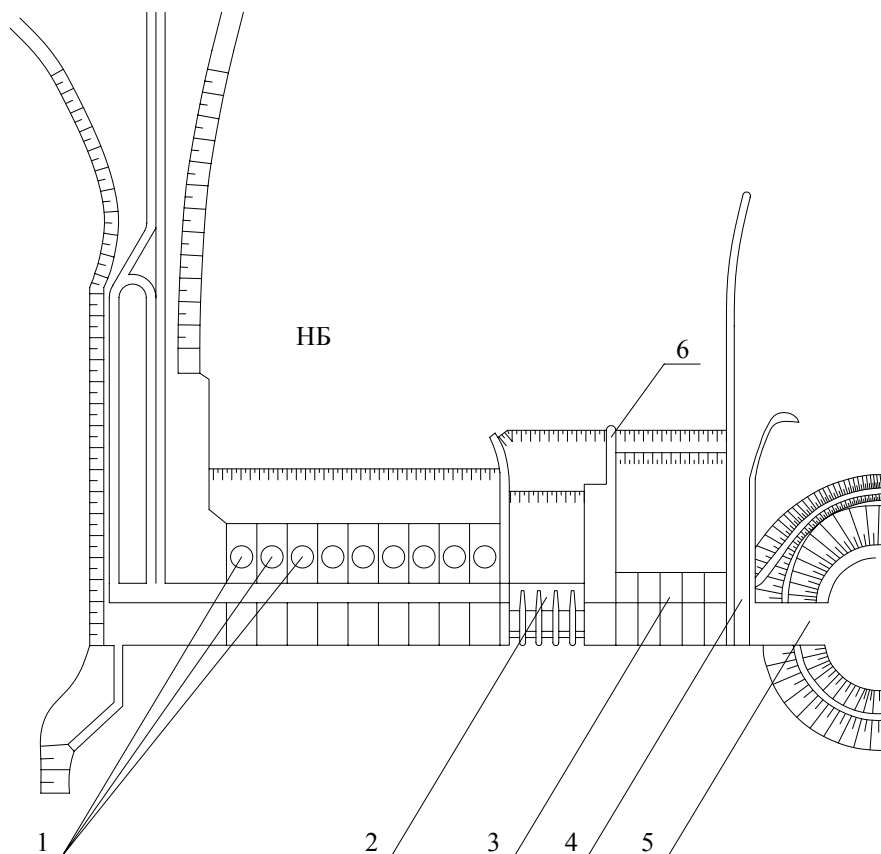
Компоновка водопропускных сооружений Богучанского гидроузла: 1 – гидроэлектростанция; 2 – поверхностный водосброс № 2; 3 – глубинный водосброс № 1; 4 – лесопропускное сооружение; 5 – грунтовая плотина; 6 – разделительная стенка между водосбросами 1 и 2
